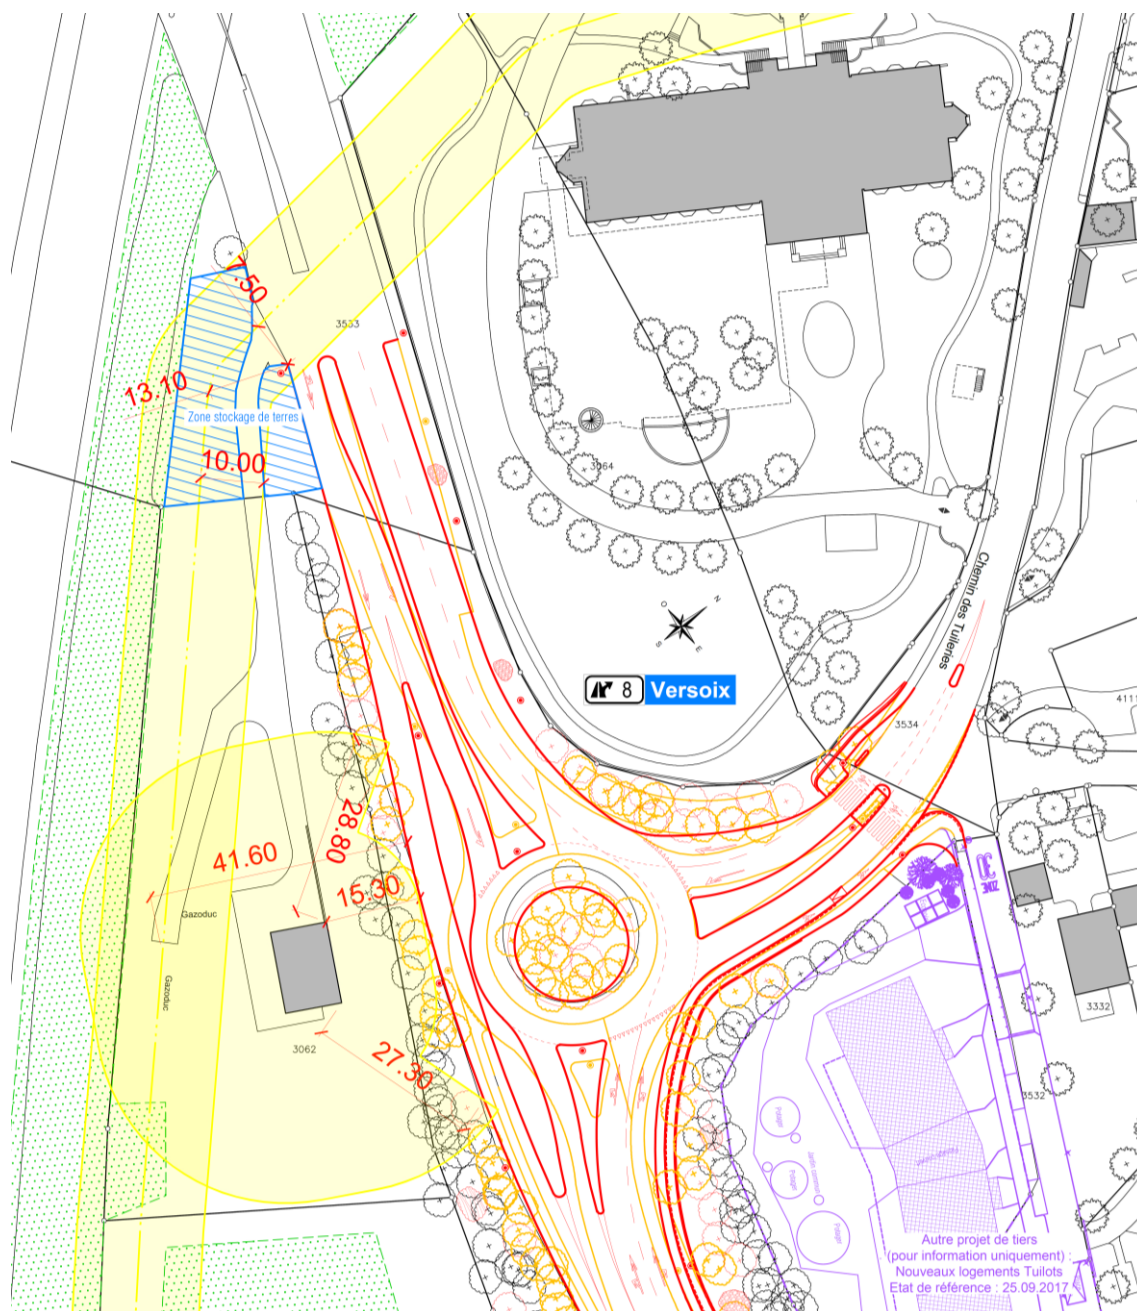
Extrait du plan de situation (source : Groupement VERO)
